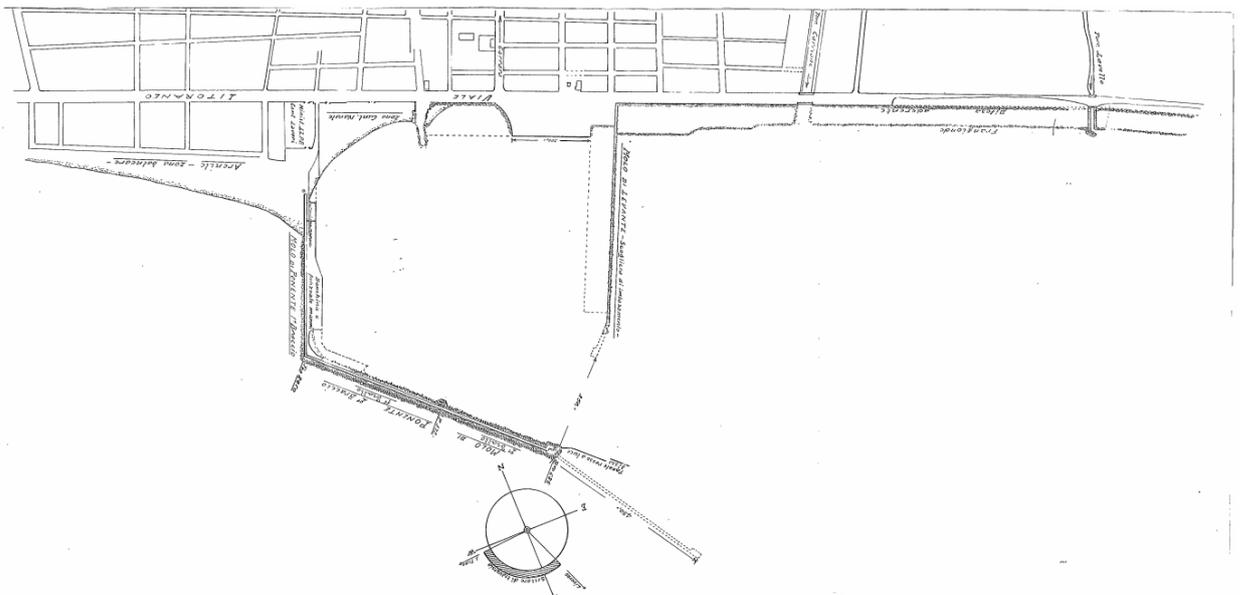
Planimetria del 1951 (fonte: Archivio OO.MM.)
